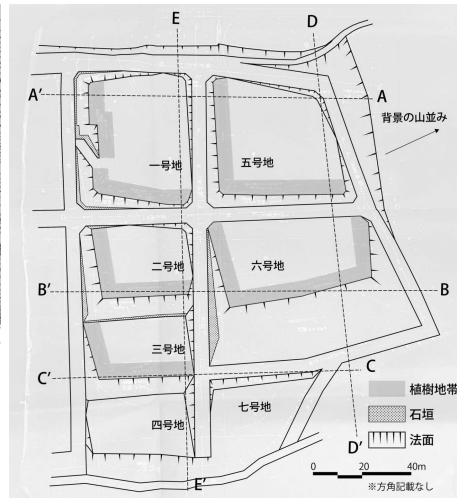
設計変更前の平面図(図面をトレース, 文字を加筆)
